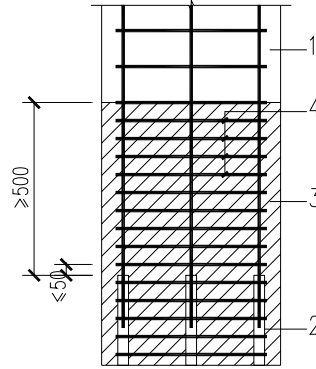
钢筋采用套筒灌浆连接时柱底箍筋加密区域构造示意
